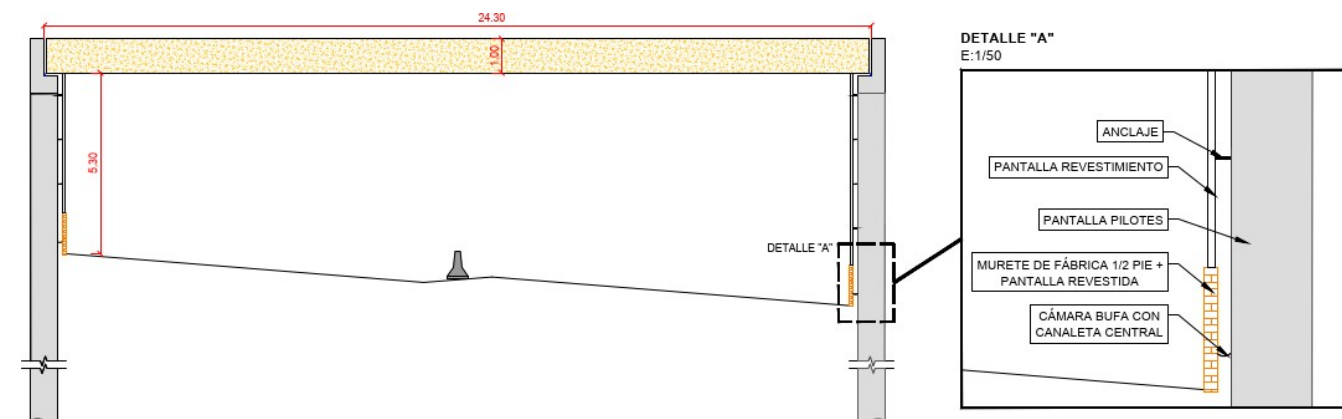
Detalle del interior del muro pantalla de pilotes. Cámara bufa y canaleta. Planos Anejo 11. Estructuras.
